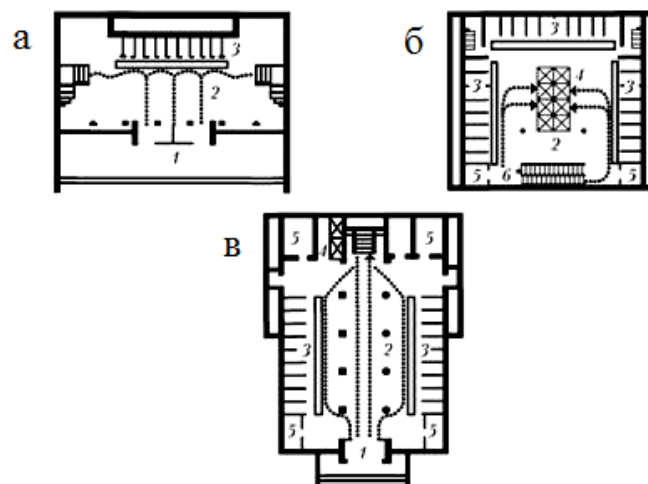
Планувальні схеми вестибюлів в громадських будівлях: *а* – у видовищному будівлі (театр); *б* – у цокольному поверсі будівлі (проектний інститут); *в* – вестибюль поздовжнього типу; 1 – тамбур; 2 – вестибюль; 3 – гардероб; 4 – ліфти; 5 – допоміжні приміщення; 6 – ескалатори
